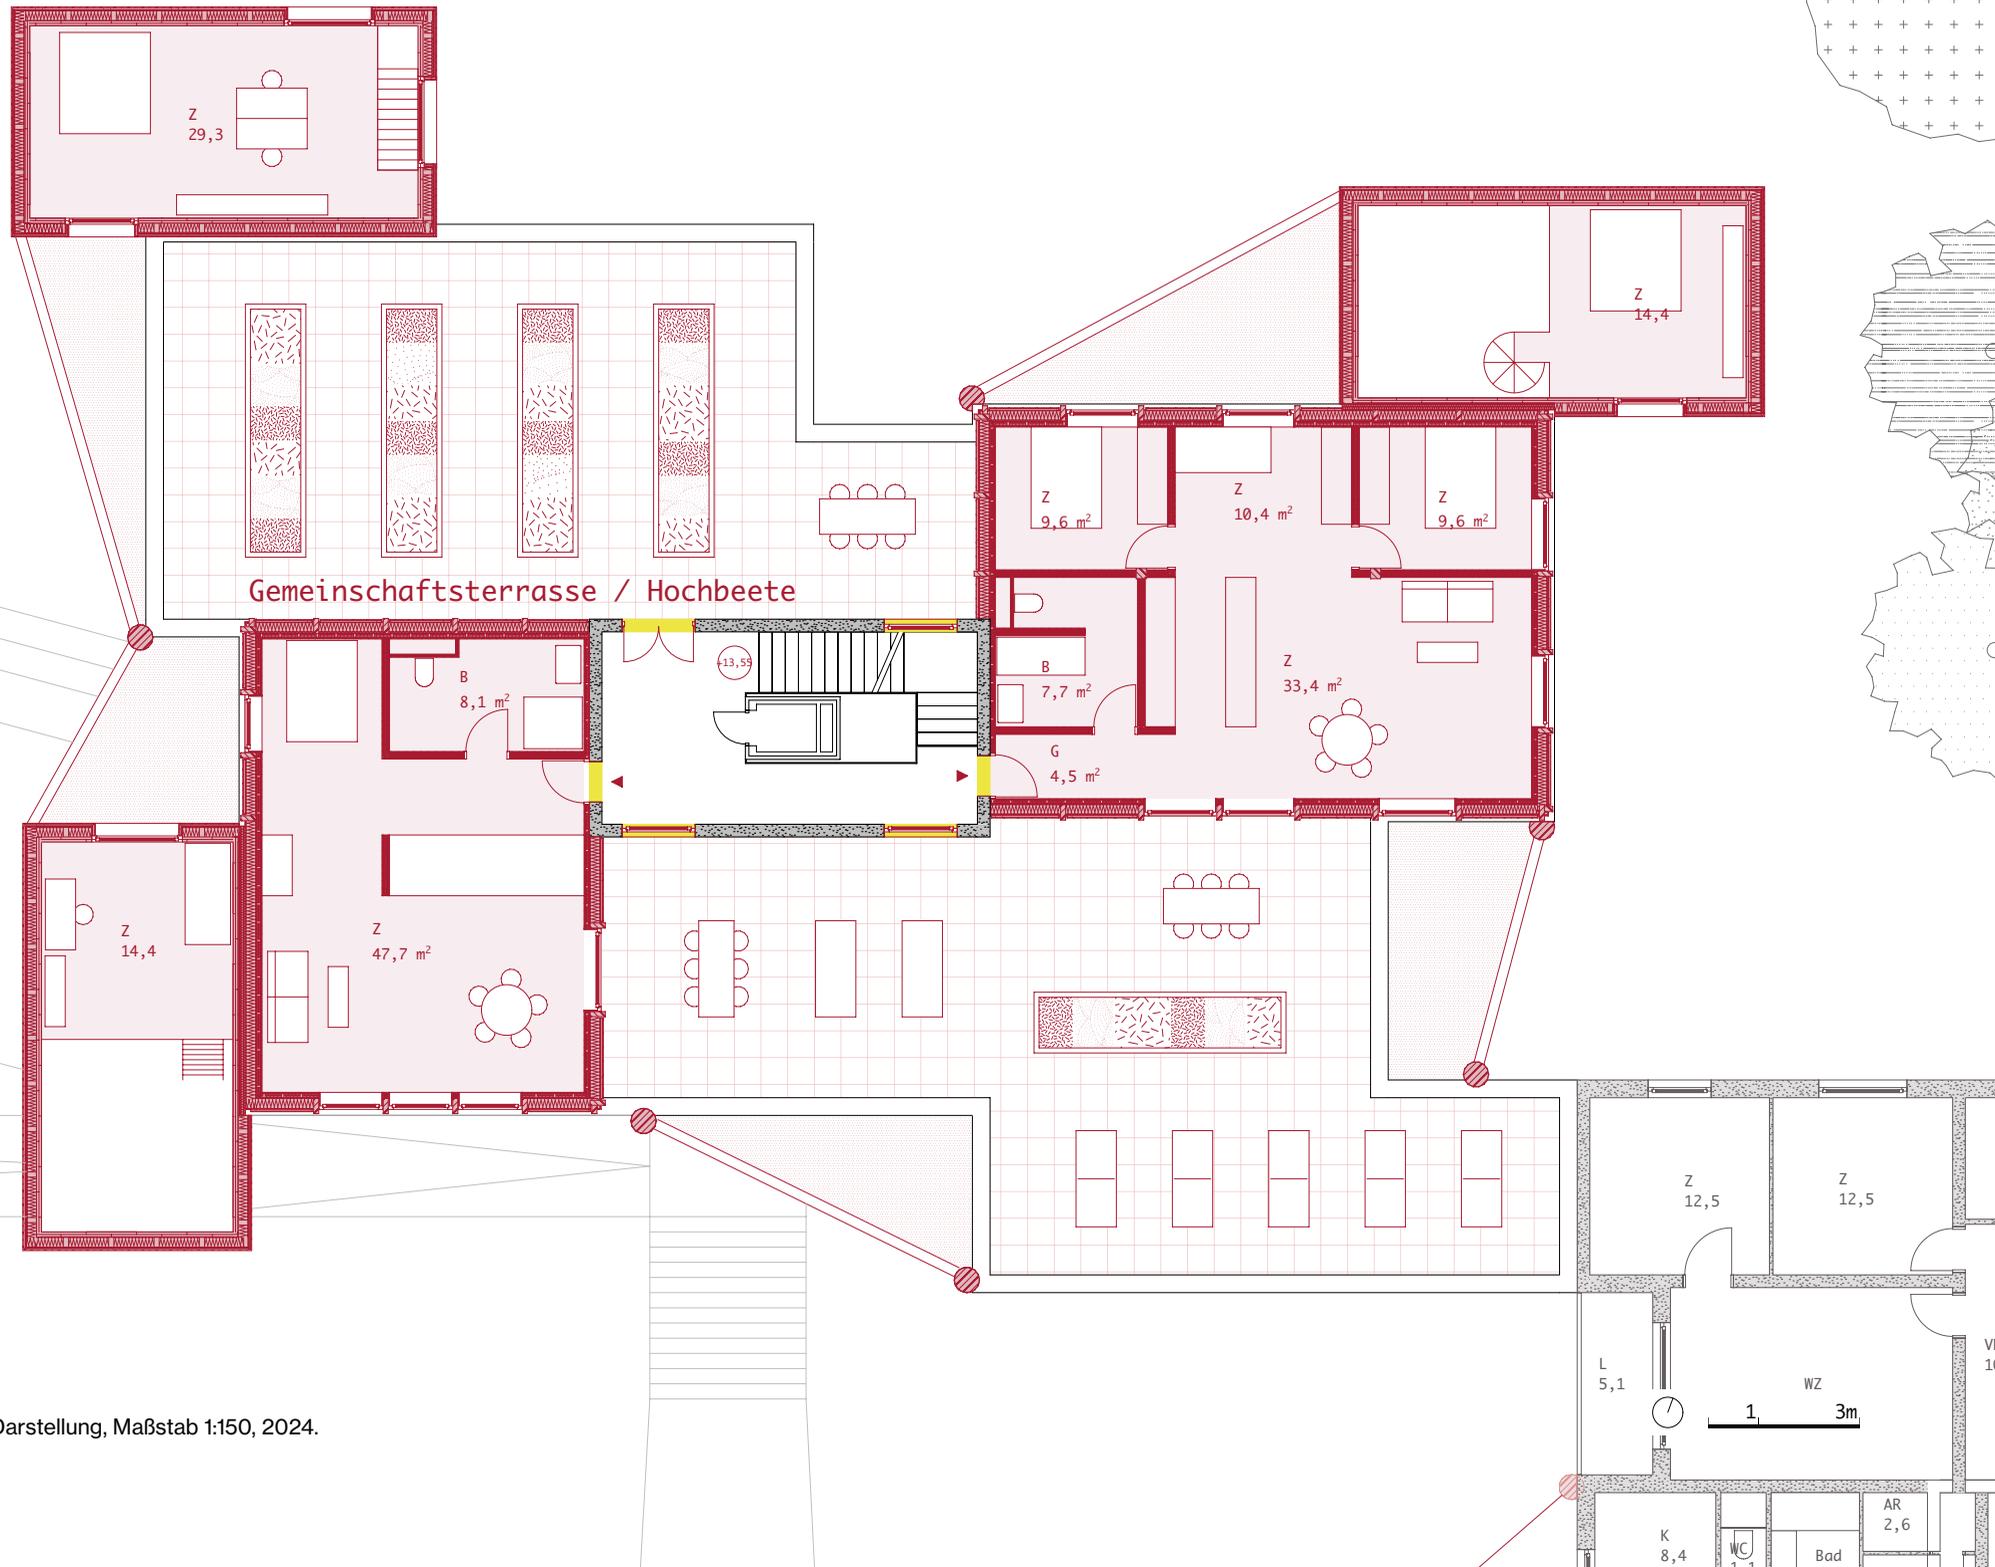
Dachgeschoss mit Gemeinschaftsterrasse mit zusätzlichen Einheiten, Eigene Darstellung, Maßstab 1:150, 2024.
